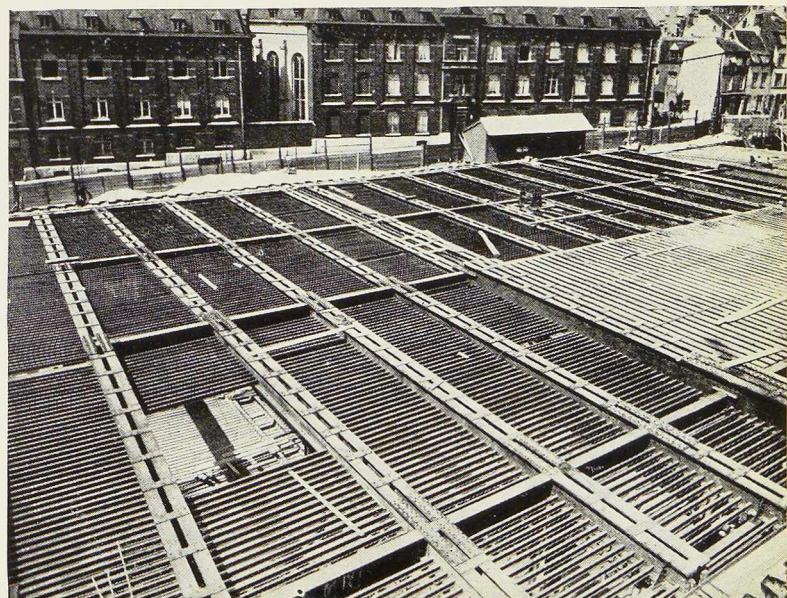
Vue du poutrellage des premières sections de l'ossature des pertuis du tunnel de la Jonction Nord-Midi.
